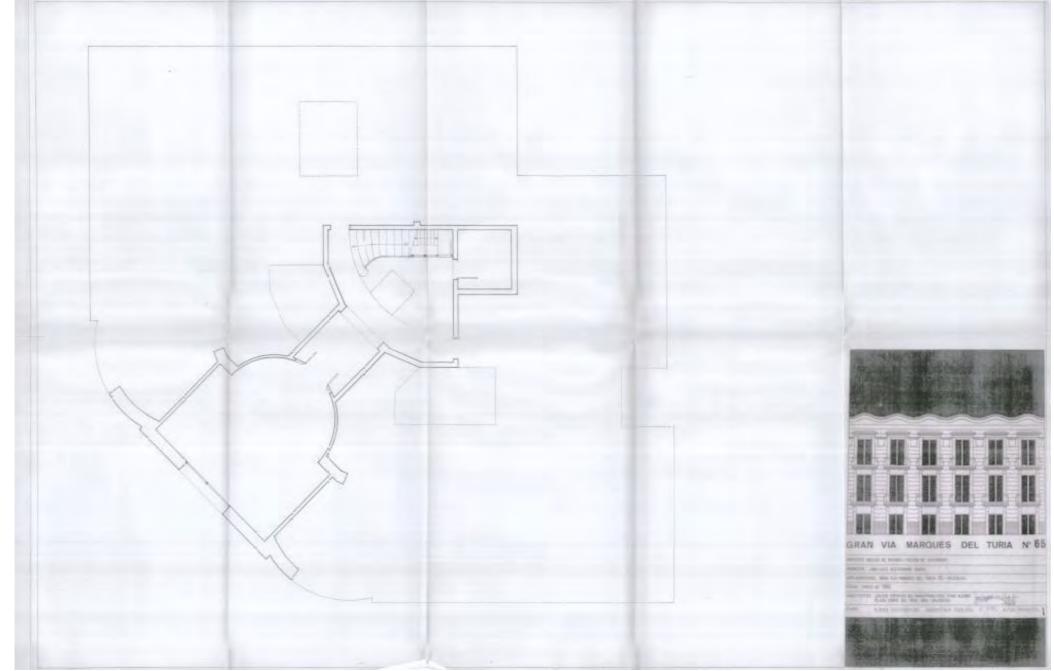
Planta baja estado actual proyecto de rehabilitación 1985
